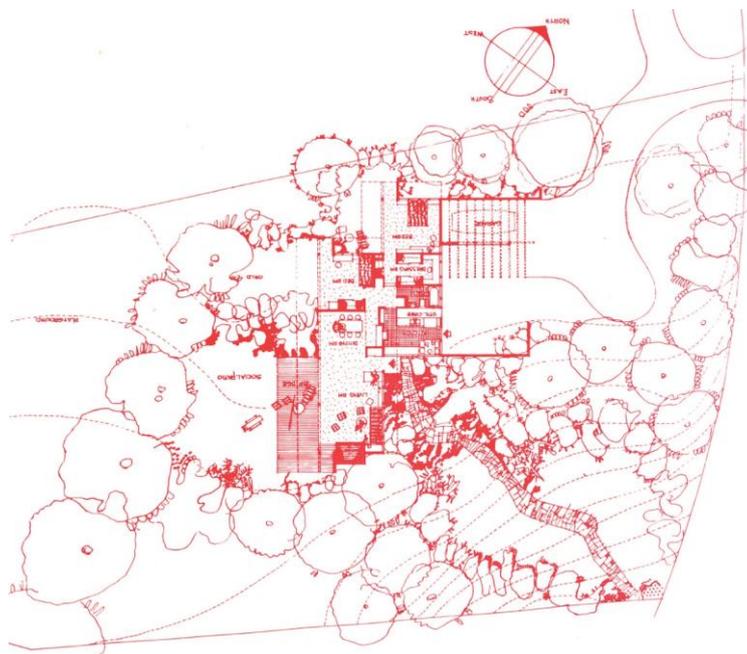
Planta Bailey House, Los Ángeles, 1946-1948.
